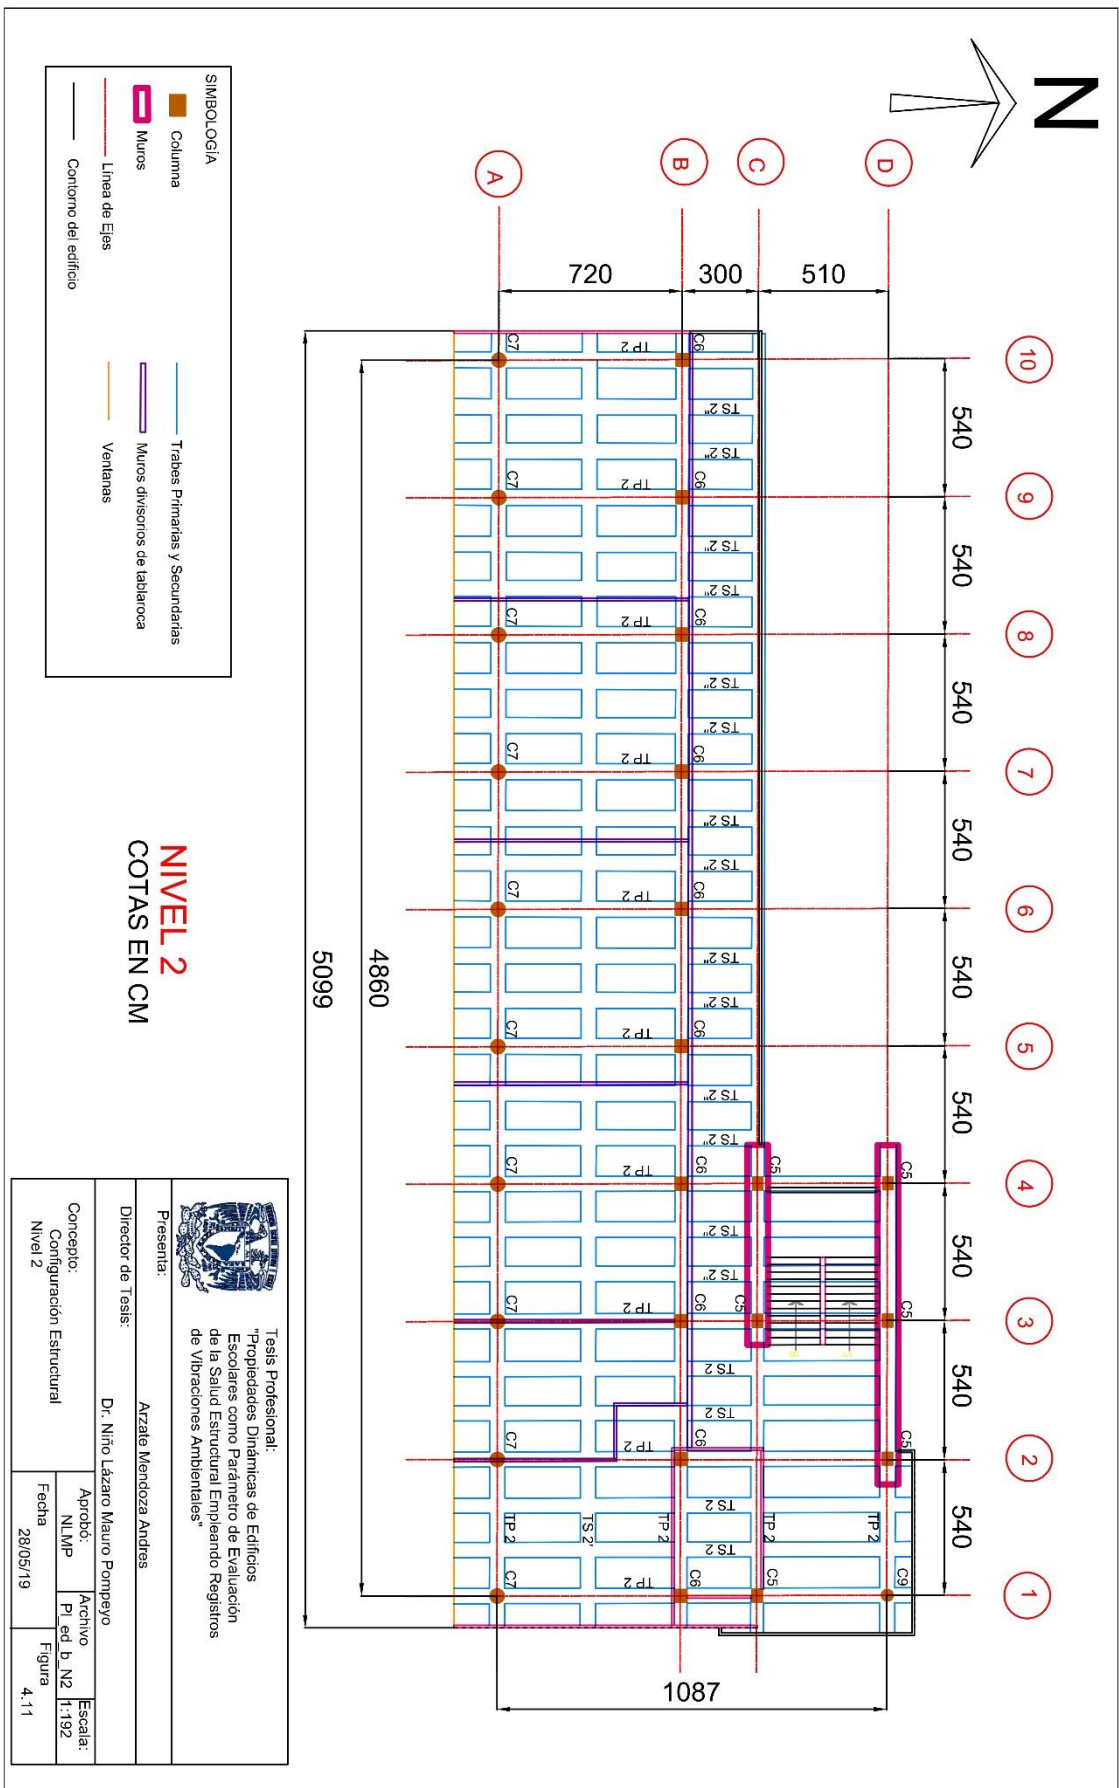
Planta estructural nivel 2 edificio B FI, UNAM
